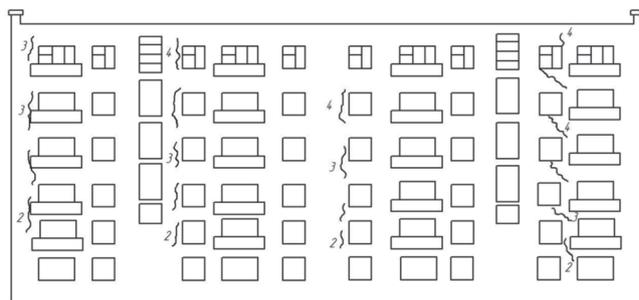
Дом 48. Трещины стены дворового фасада
